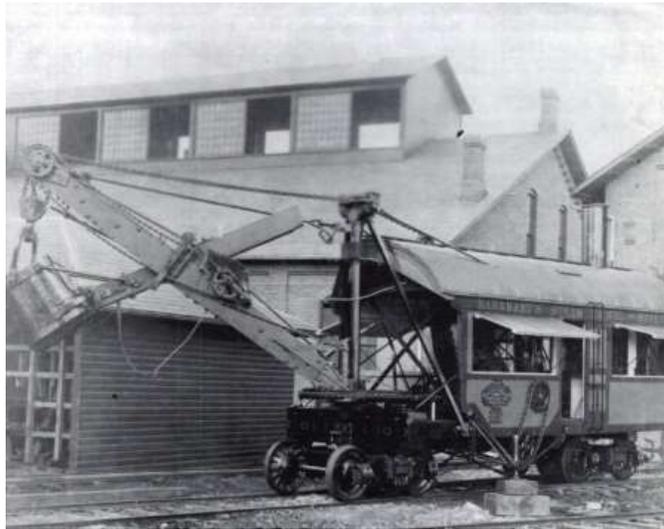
Escavadeira Barnhart Style A, design de 1883.
